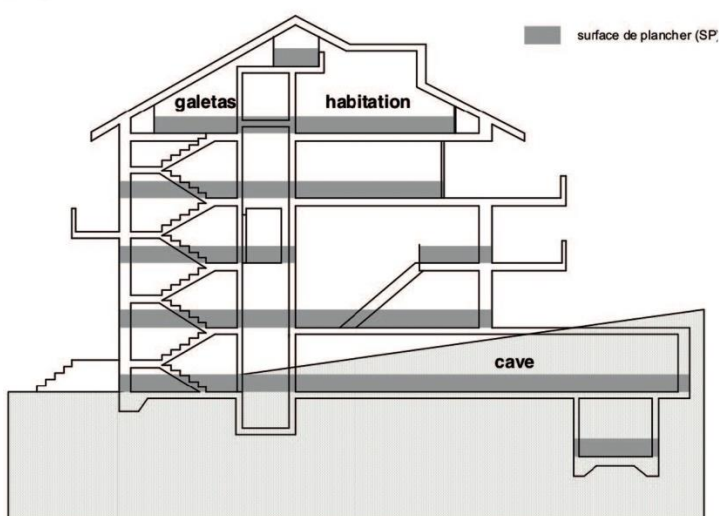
surfaces de plancher au-dessus du sol d'un bâtiment en coupe
